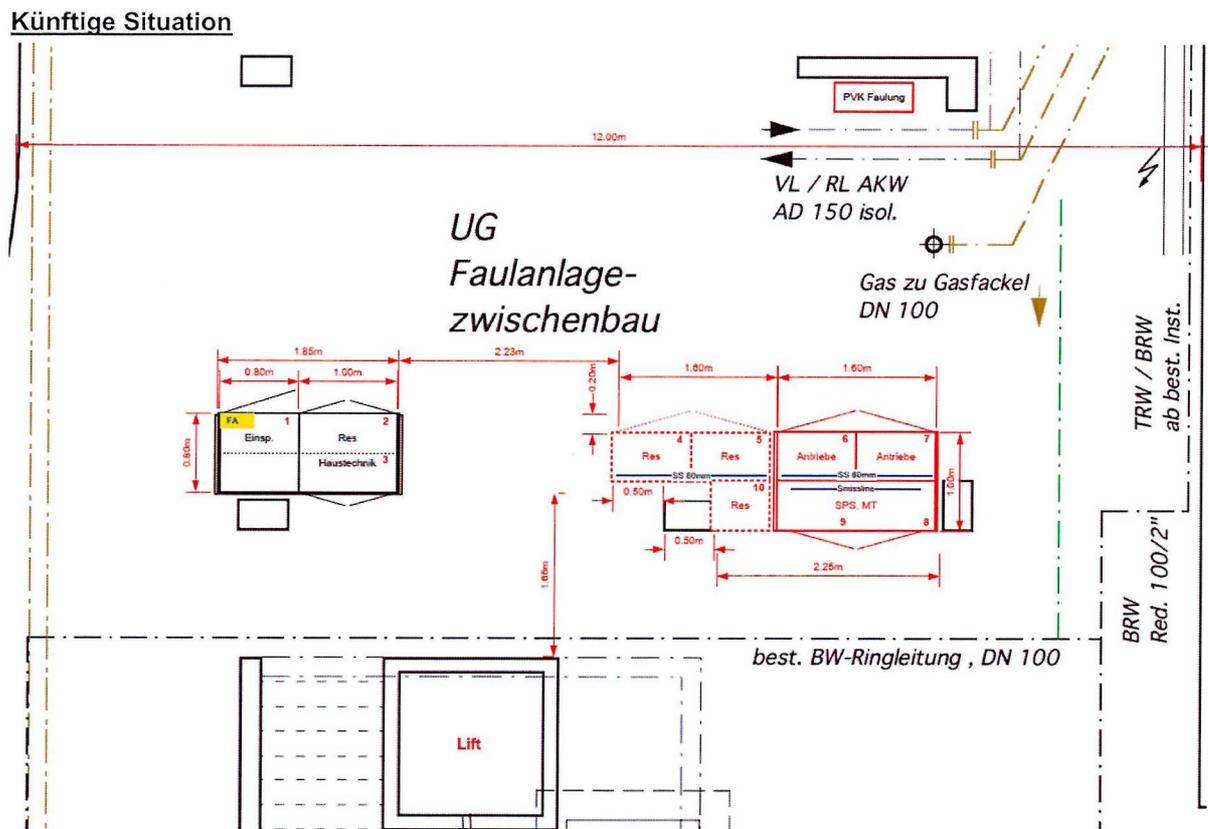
Künftiger Grundriss Faulanlage-Zwischenbau UG (rot = neu)
